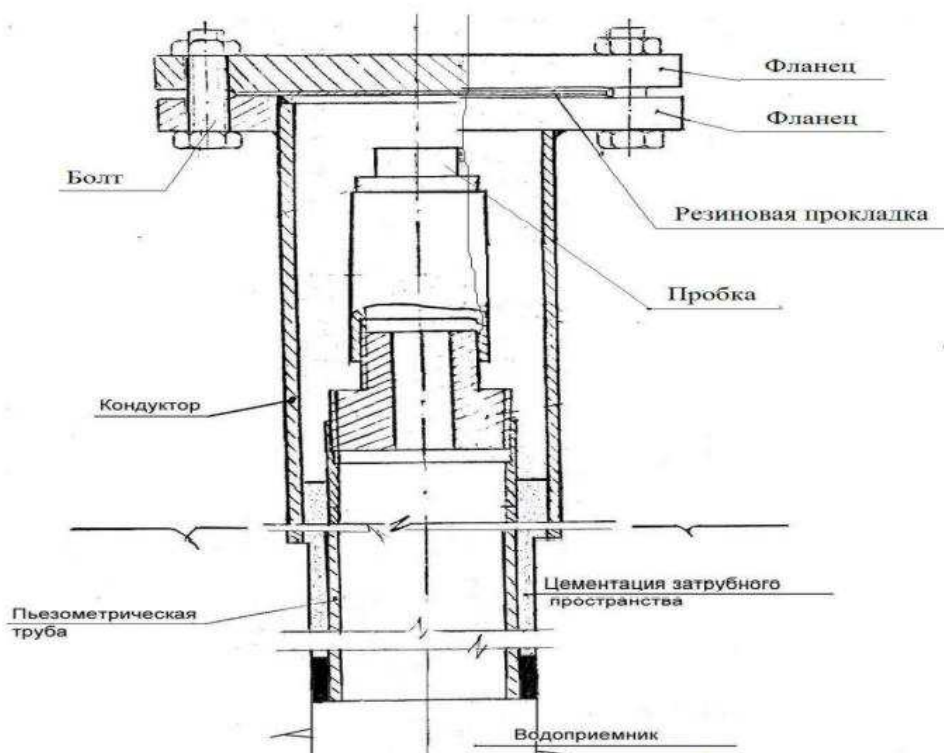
Схема устройства безнапорного пьезометра
